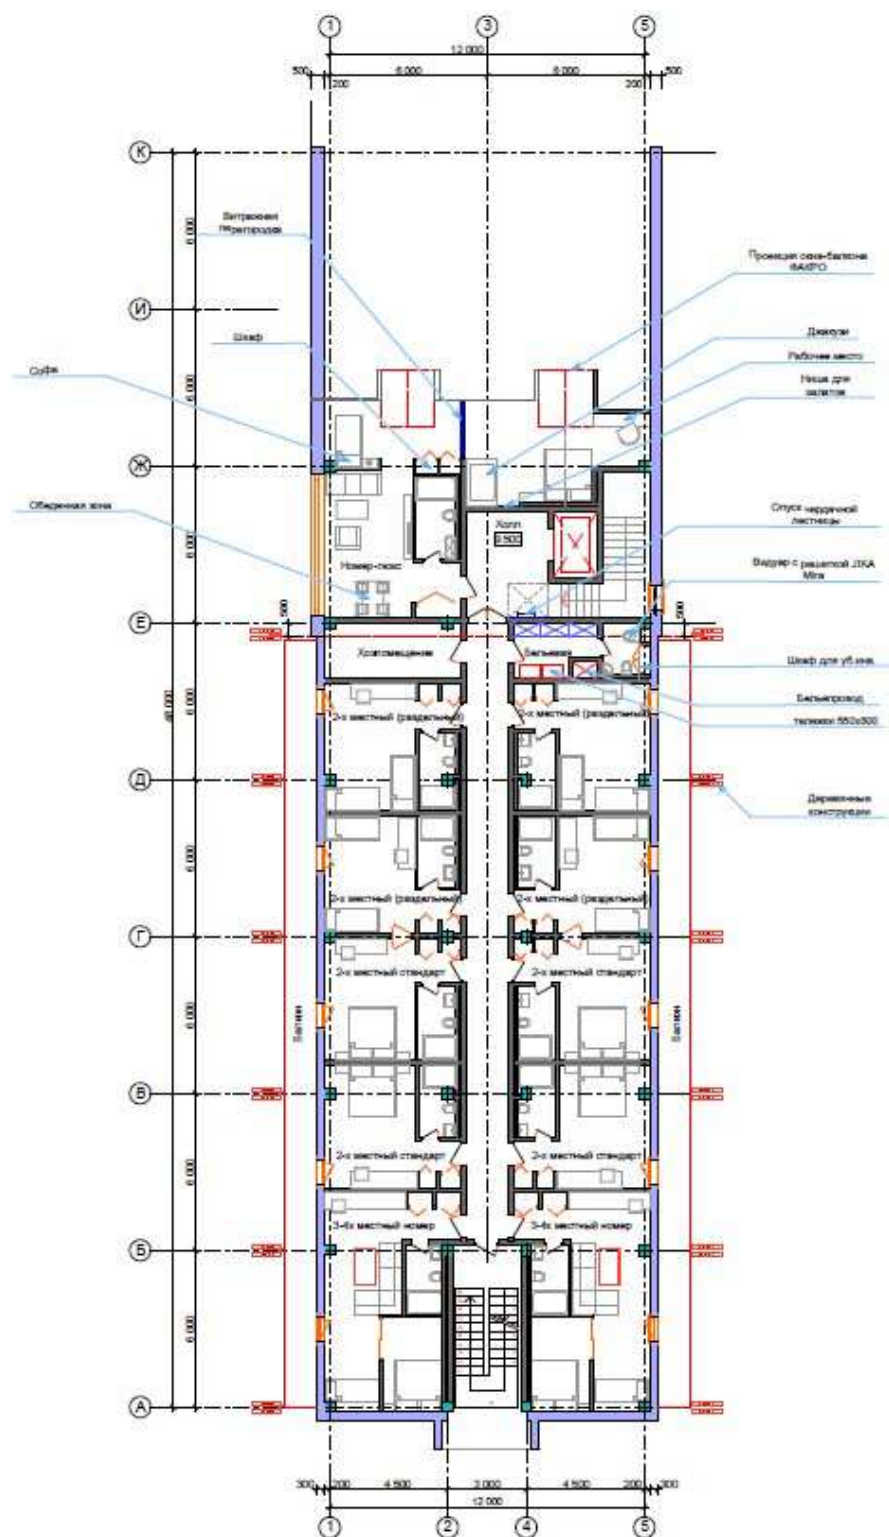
План 4-го этажа (на отм. +9,500)
